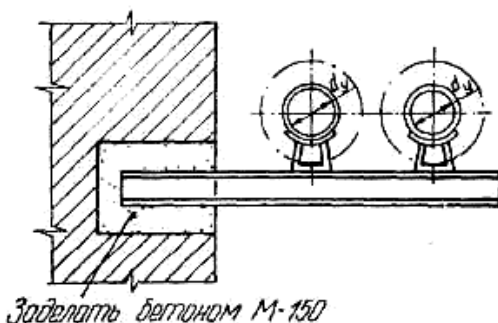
Прокладка теплопроводов на кронштейнах
